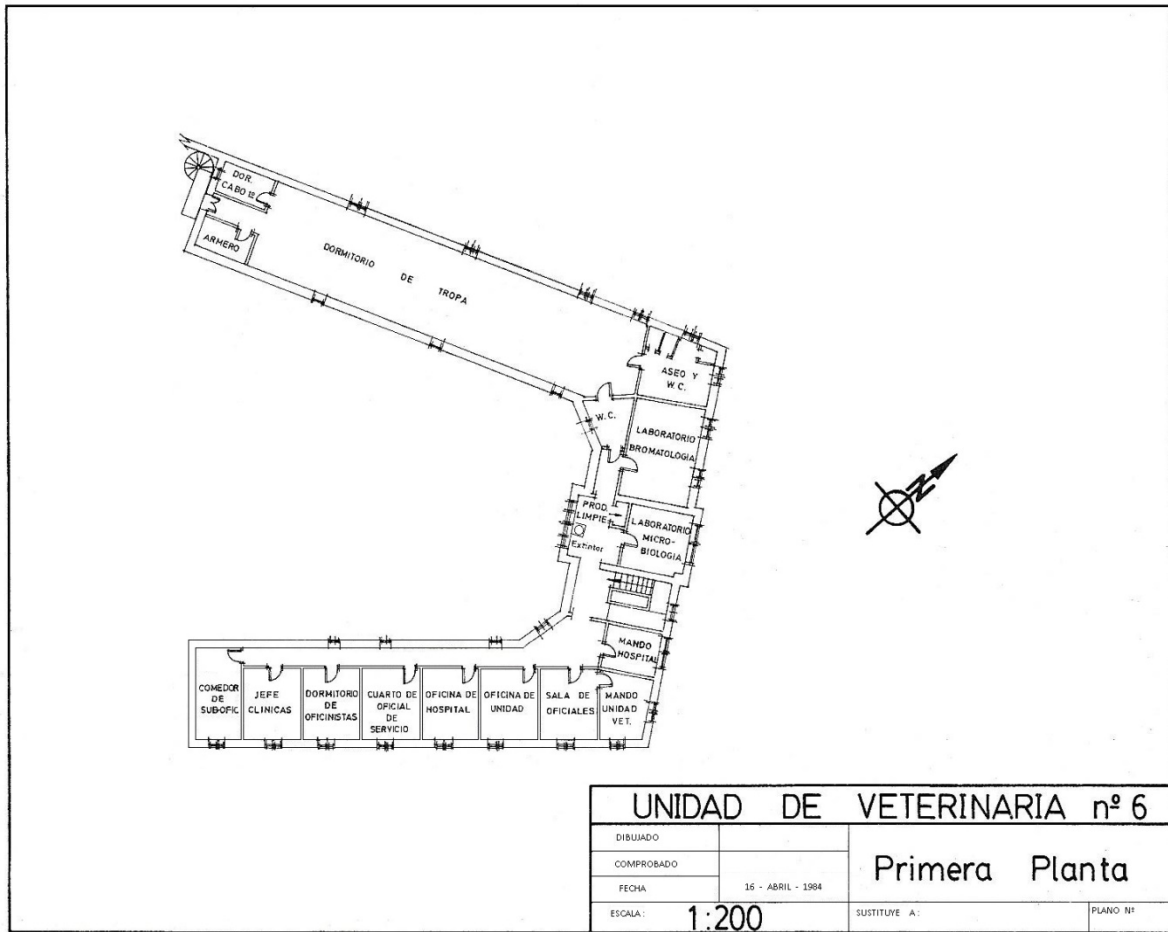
Plano de la primera planta del cuartel de Veterinaria (1984)
